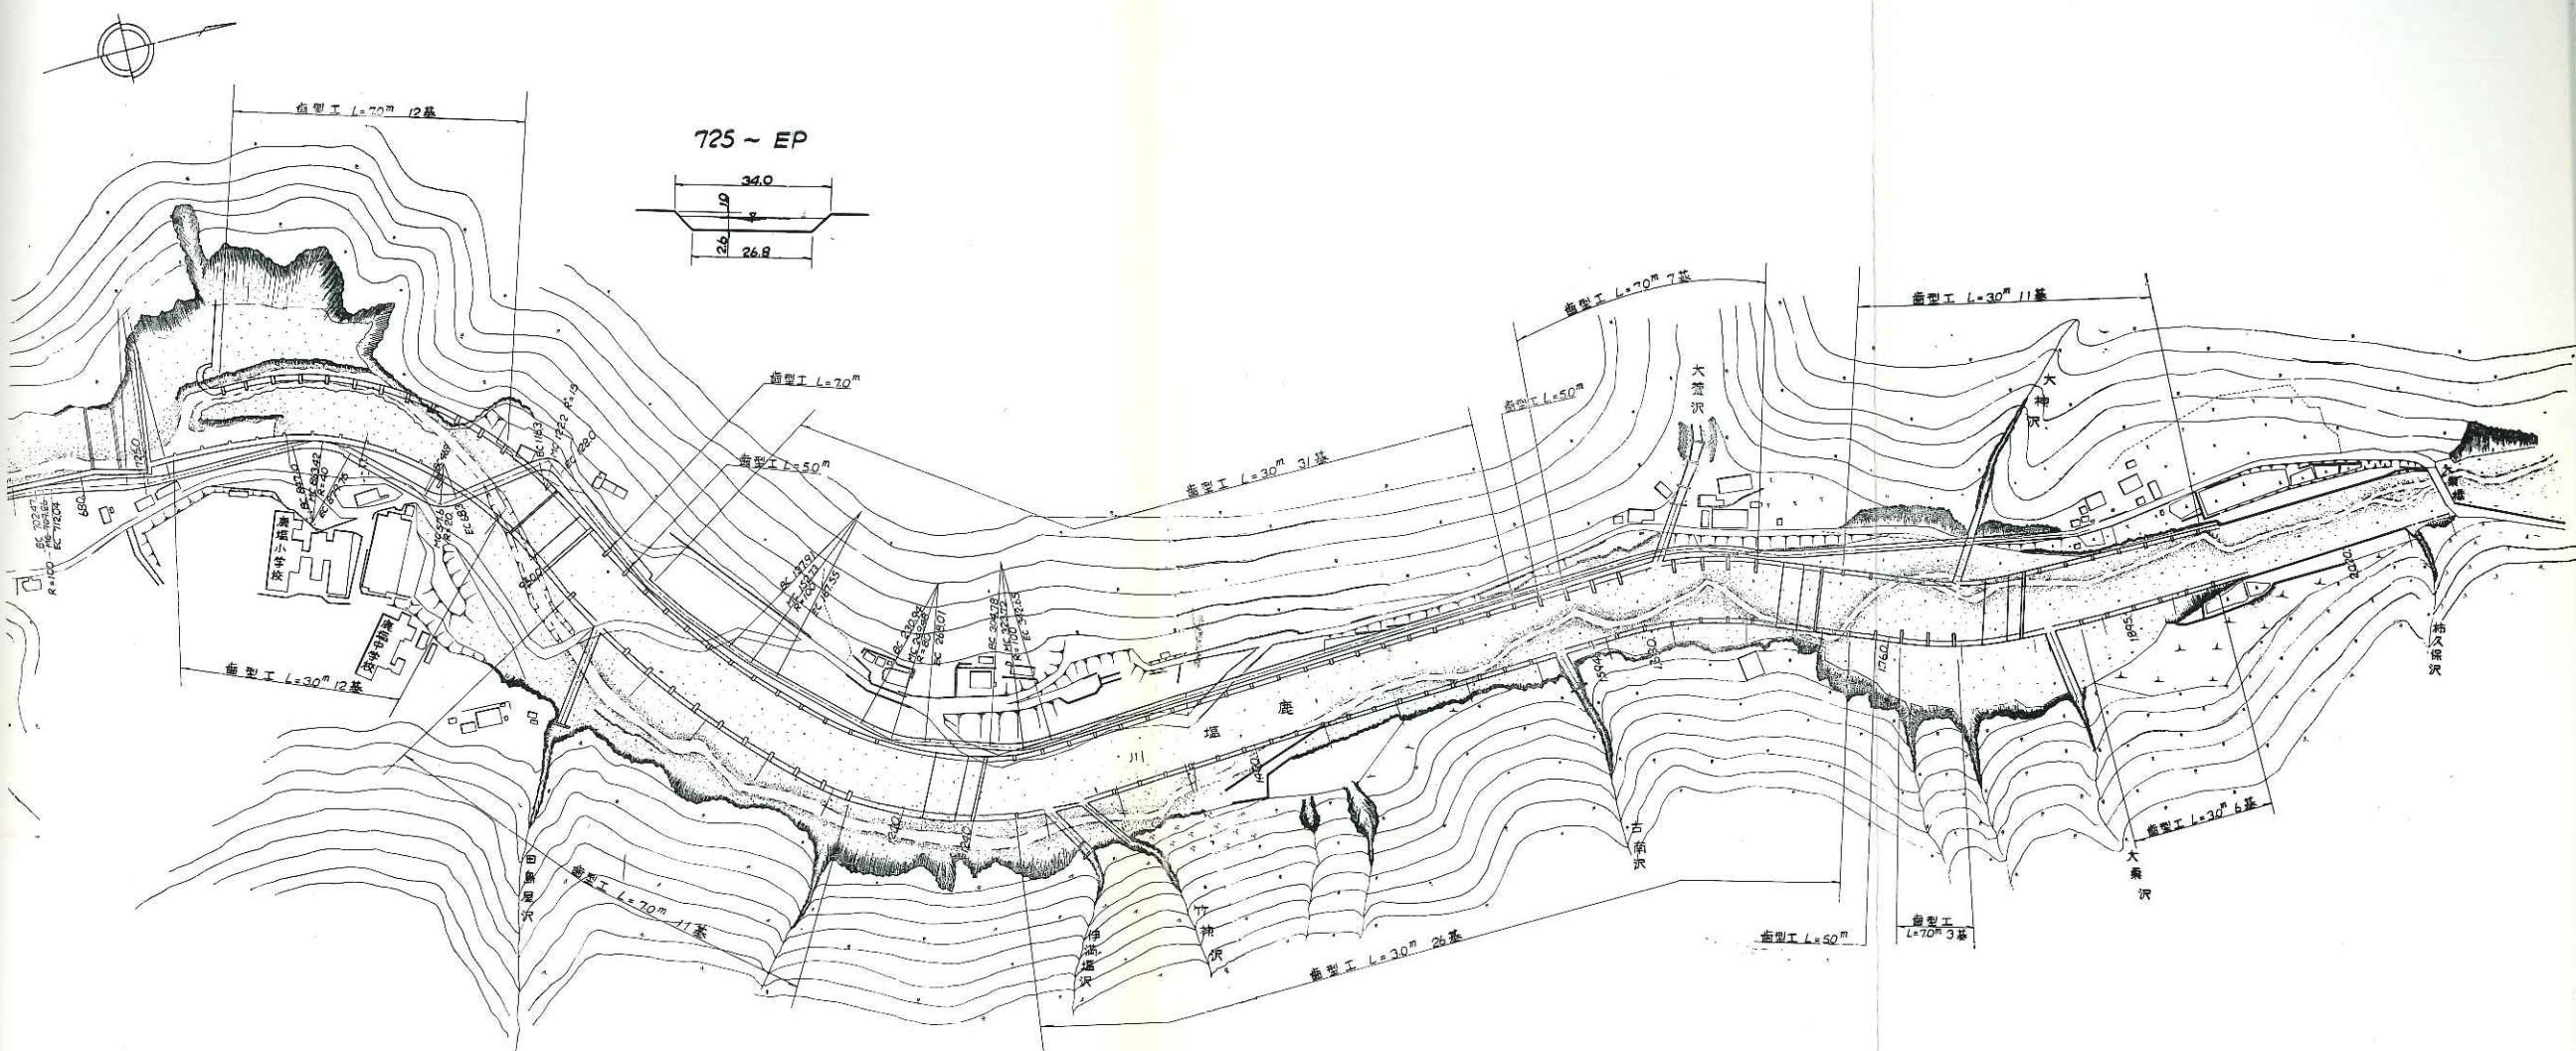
鹿塩川平面図 縮尺 1/4,000 (3)
